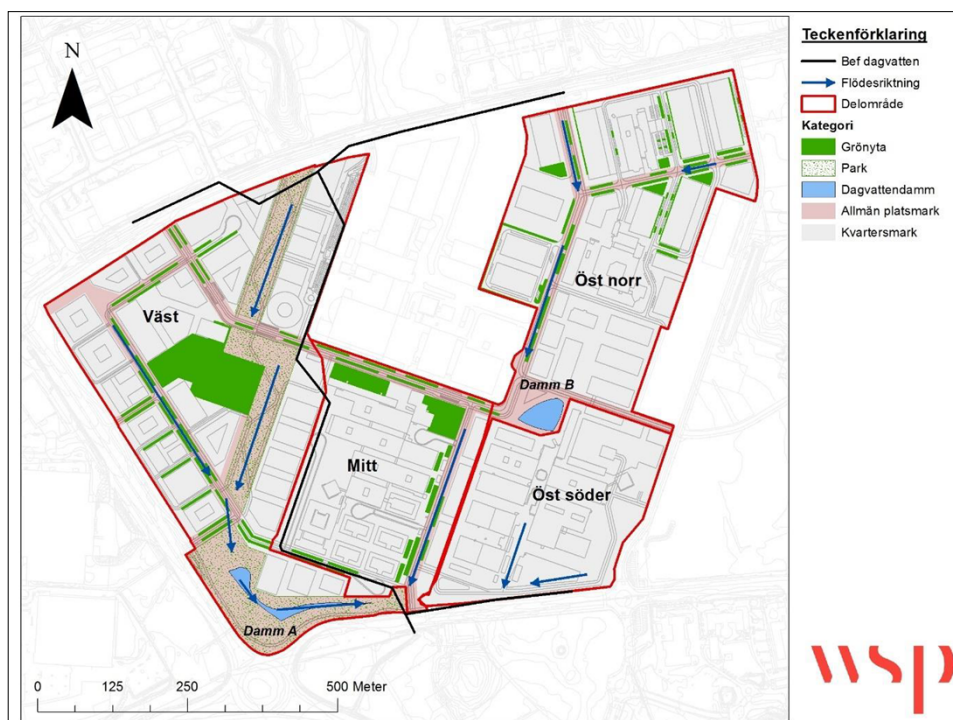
Avvattningsplan för föreslagen systemlösning för dagvattenhantering inom utredningsområdet. Illustration WSP.
